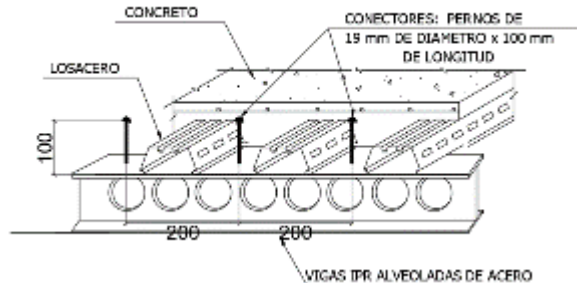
Detalle de losa de soffito metálico o losacero apoyada sobre vigas alveoladas. Fuente: Cáceres (2021).
